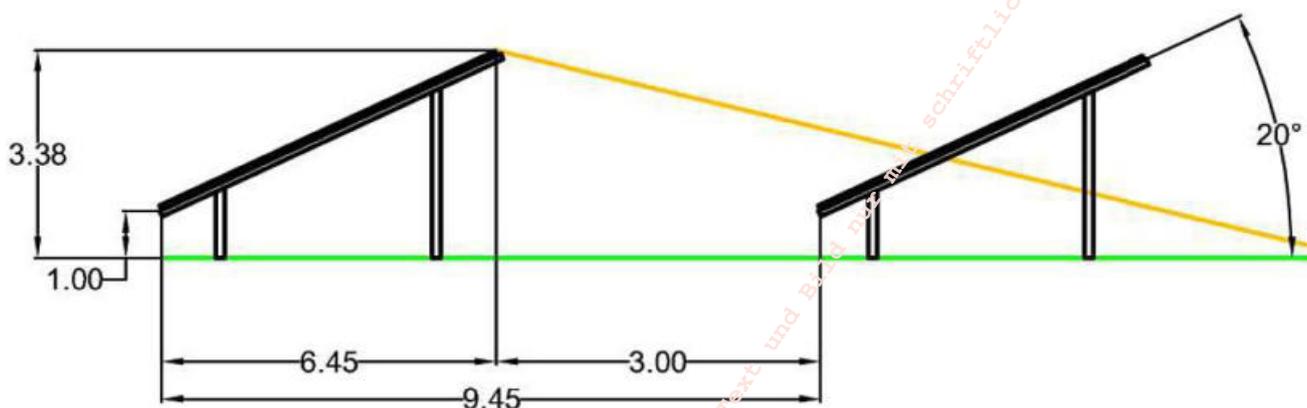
Skizze der Modulkonstruktion (Quelle: Planungsunterlagen)
